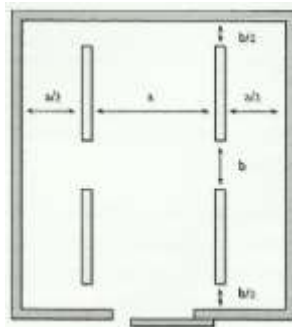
Método de cálculo para a disposição de armaduras de iluminação (Cunha, 1999)
